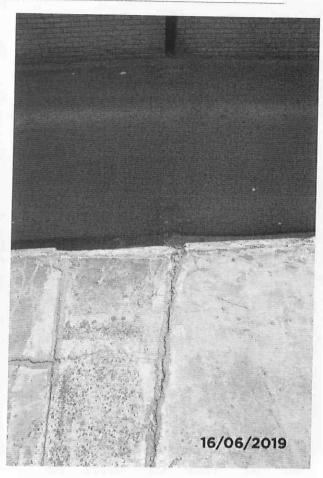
Vista da fissura no pavimento asfáltico e no passeio entre o encontro do viaduto e a via.
